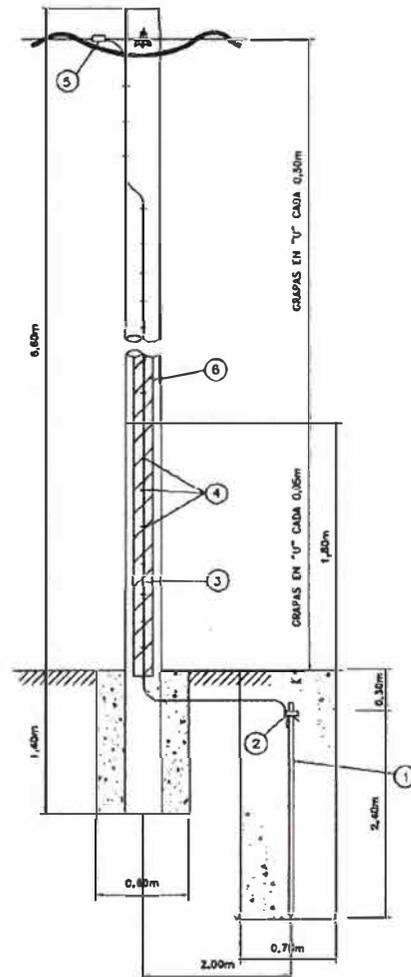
Puesta a tierra para estructuras de madera en redes secundarias.
